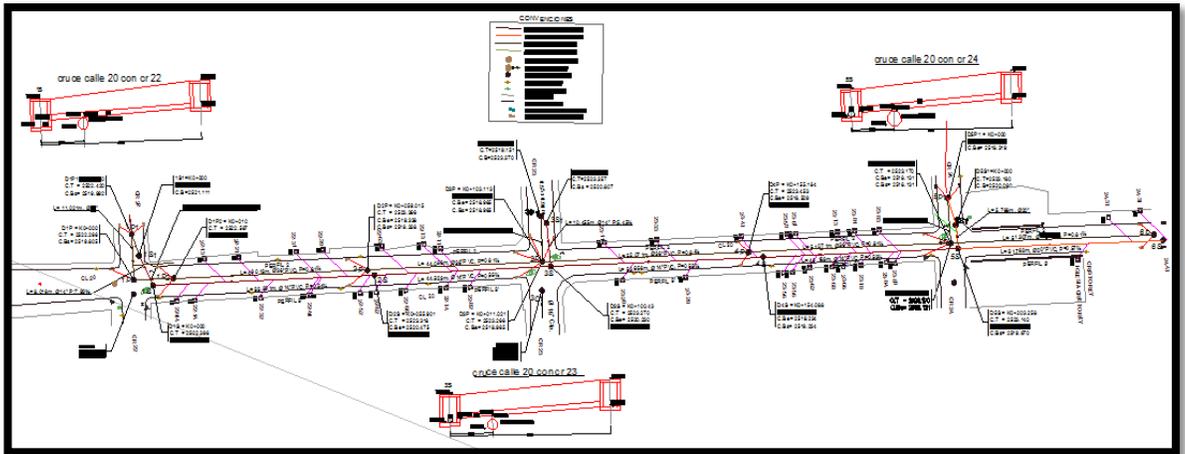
Planta de la red de alcantarillado tramo 3 (calle 20 entre carreras 24 y 27)
